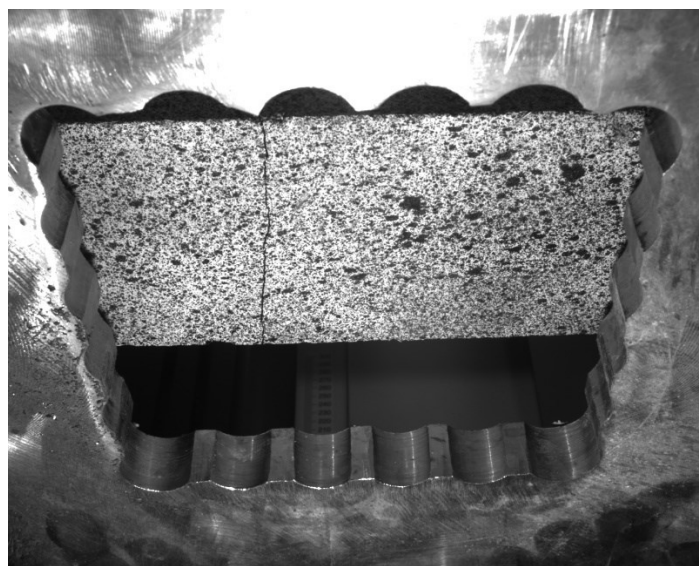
Vista dal basso durante test di flessione ciclica, formazione di singola fessurazione
